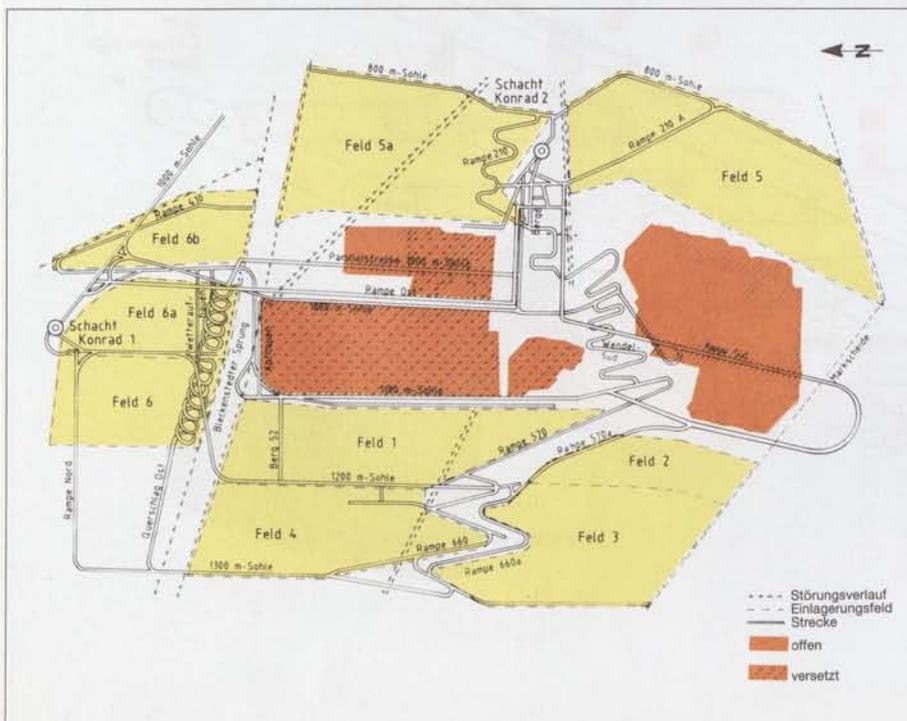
Der Grundriß des Grubengebäudes mit den Erkundungsstrecken (800-m-Sohle, 1300-m-Sohle) und den Strecken und Rampen, die aus Betriebsgründen neu erstellt wurden (z. B. Rampe Süd, Rampe Nord, Rampe Ost). In den gelb angelegten Feldern 1 bis 6 sollen die Einlagerungskammern aufgefahren werden.
